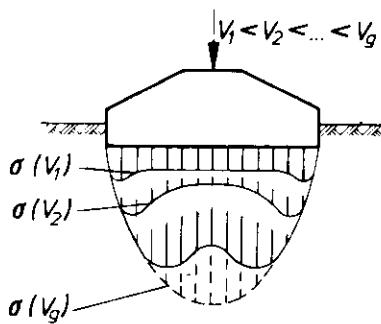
Schematische Darstellung der Entwicklung der Bodenpressungen bei wachsender Belastung eines Flächenfundaments
